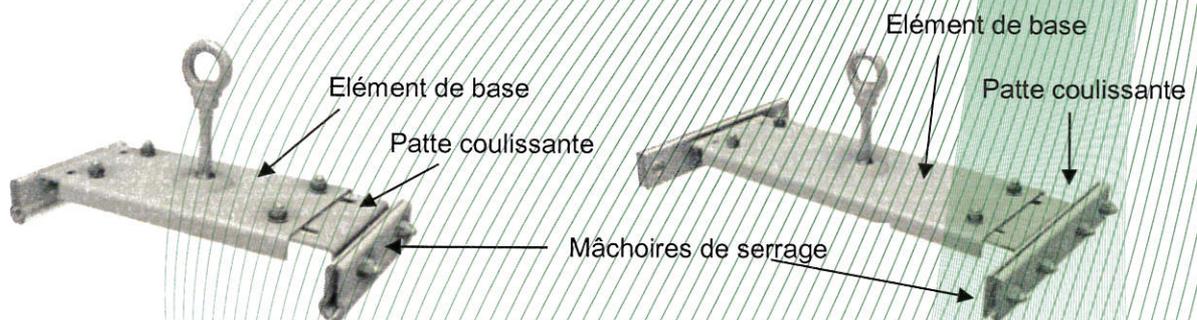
Le dispositif d'ancrage, type : LUX-top® FALZ-PLUS pour profils à joint debout
